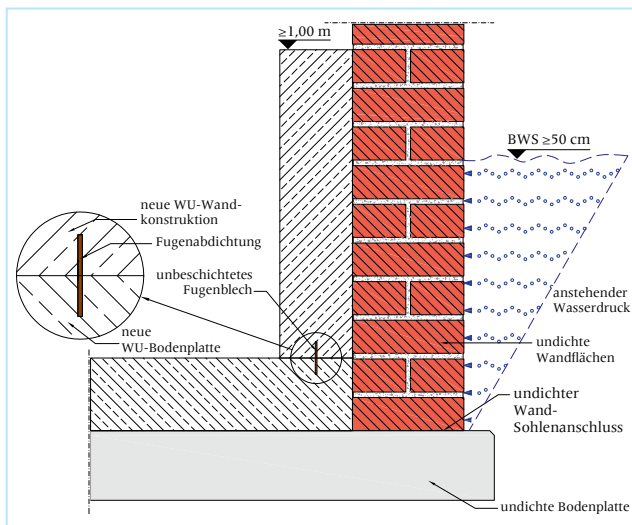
Einbauskizze einer nachträglich in den Bestand eingebauten Weißen Wanne (Bildquelle: Ralf Hunstock)
